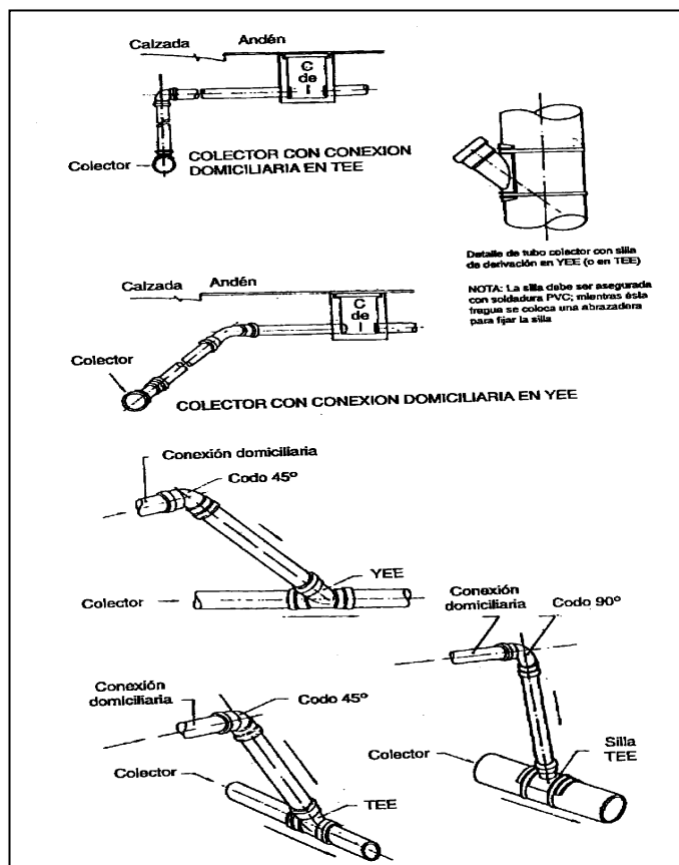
DETALLE DE CONEXION DOMICILIARIA DE ALCANTARILLADO
